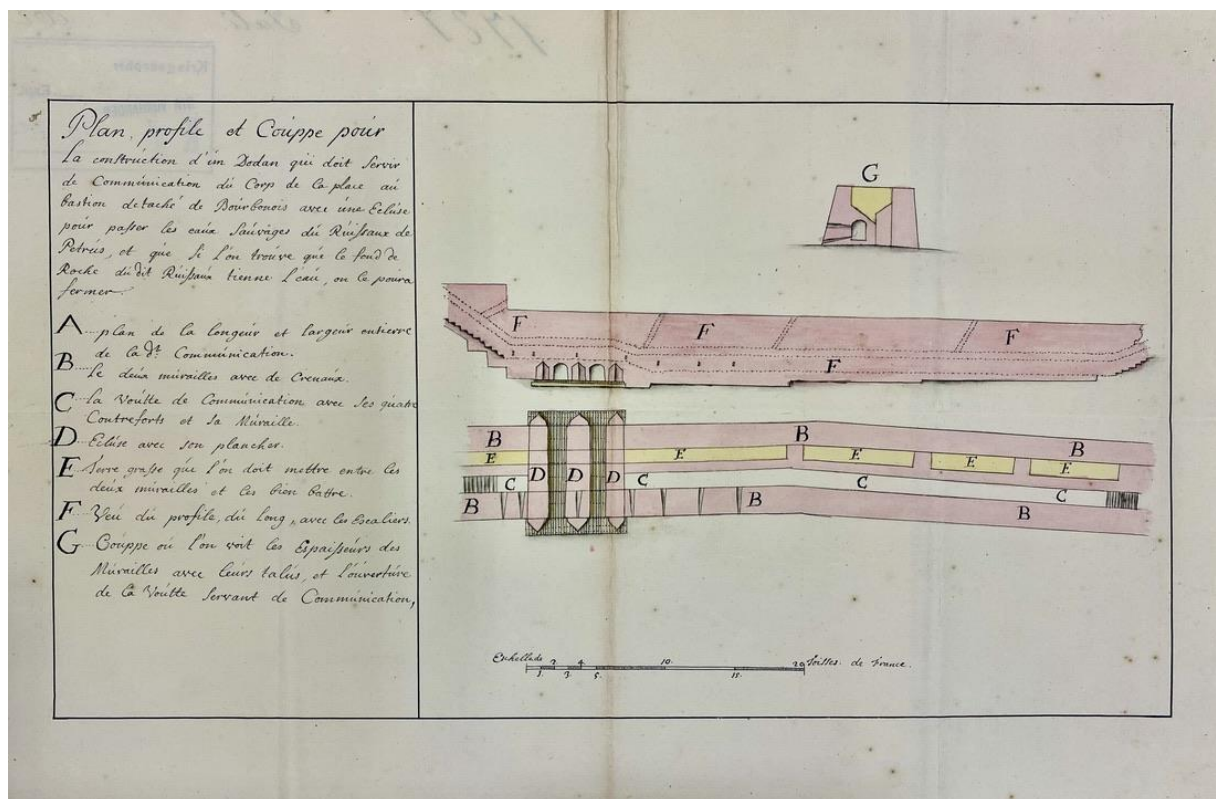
Grundriss eines Verbindungswerkes, (OeStA, KA KPS LB K VI, 37-15 E)
